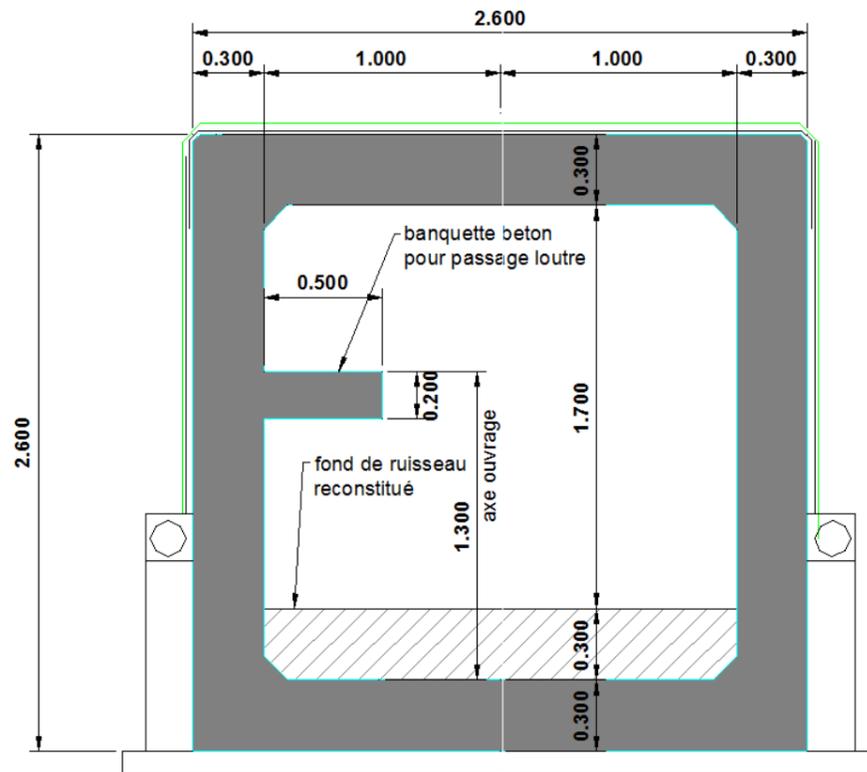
Coupe transversale de l'OH (source ARCADIS)
